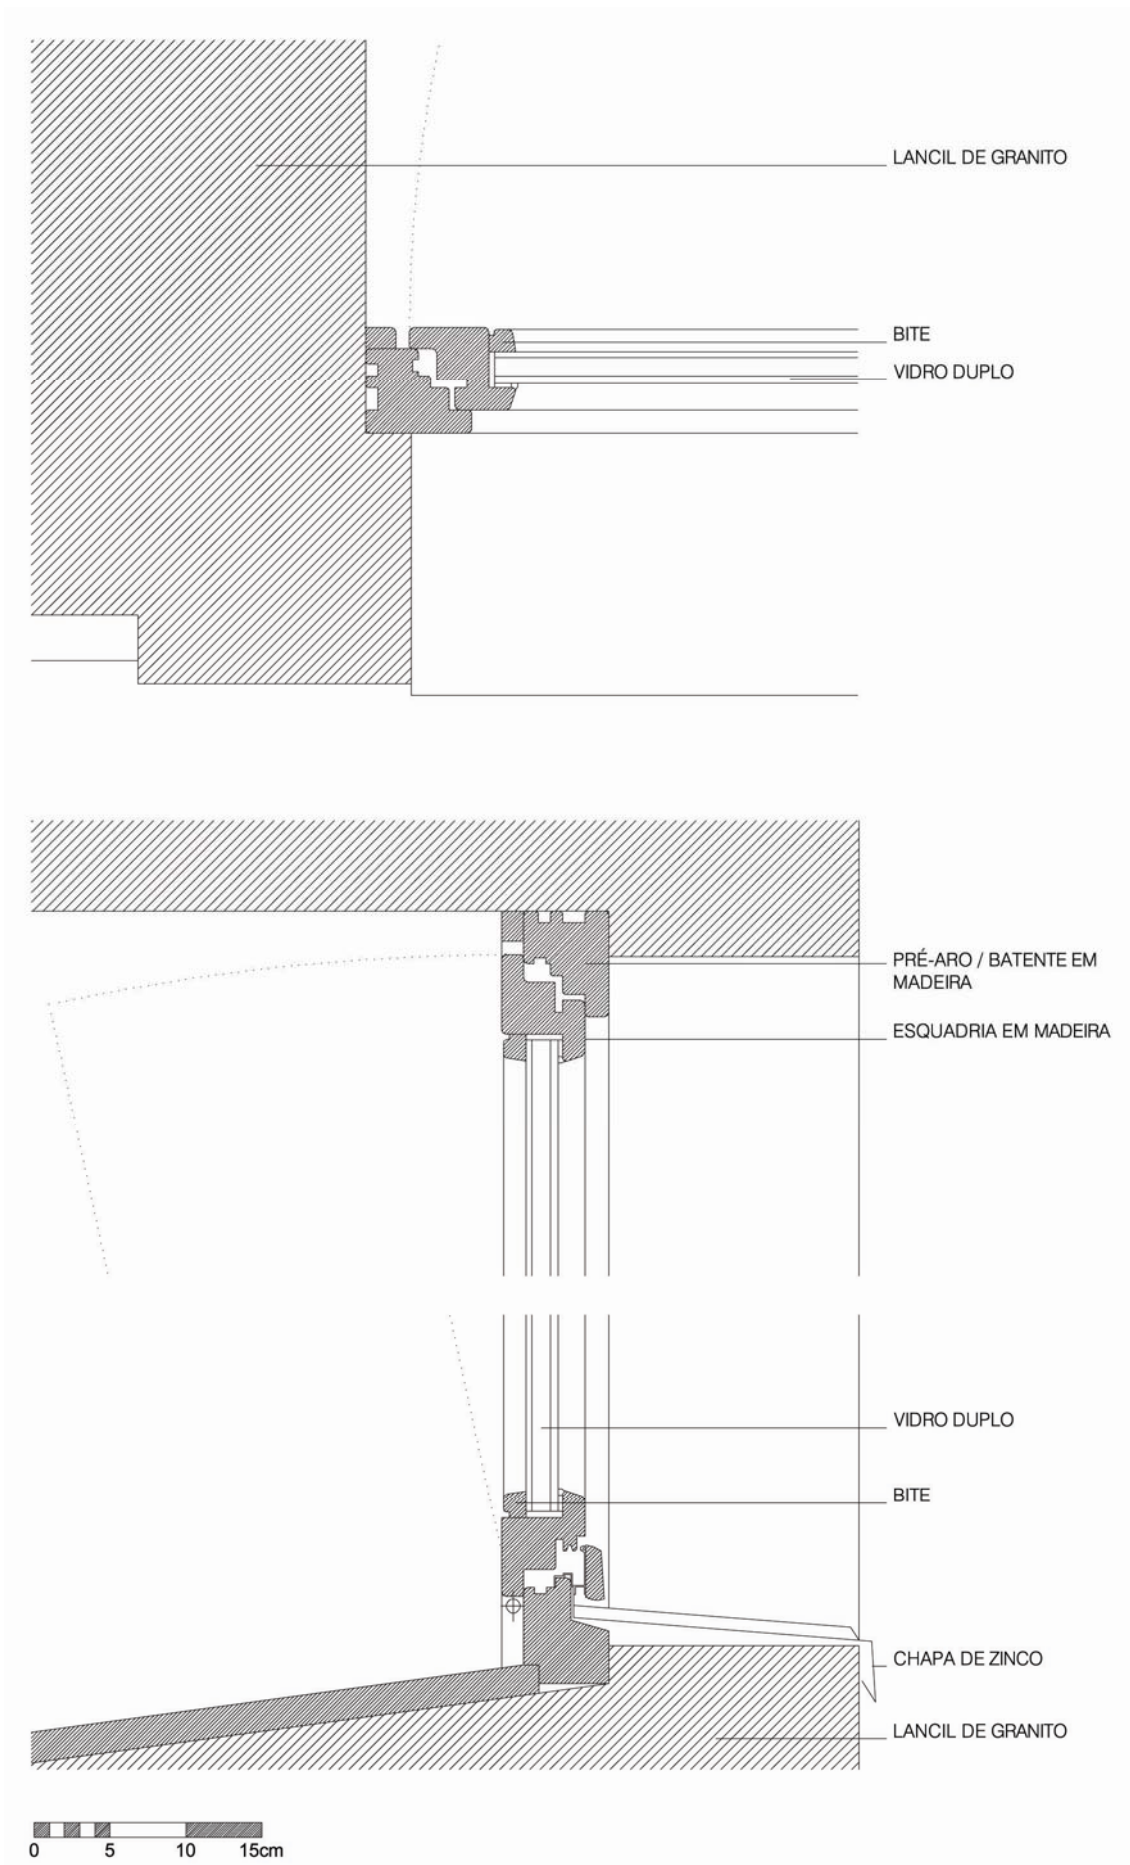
Selecção exigencial de uma nova caixilharia de madeira. Pormenor do corte horizontal e pormenor do corte vertical.
